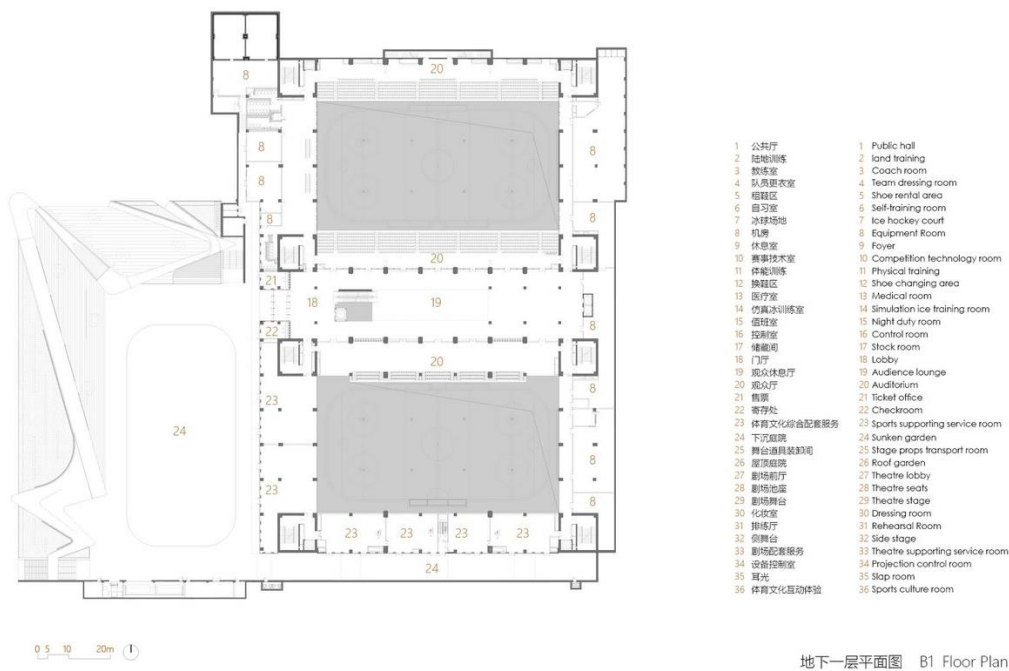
План нульового поверху, арх. VIAD-ZXD ARCHITECTS [1]
